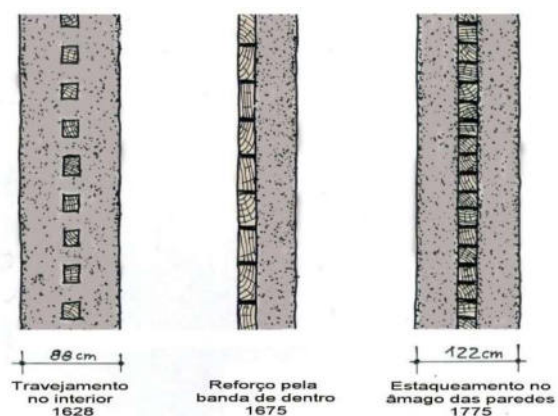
Taipa de pilão reforçada com madeira, utilizada nas cadeias, vista em planta
